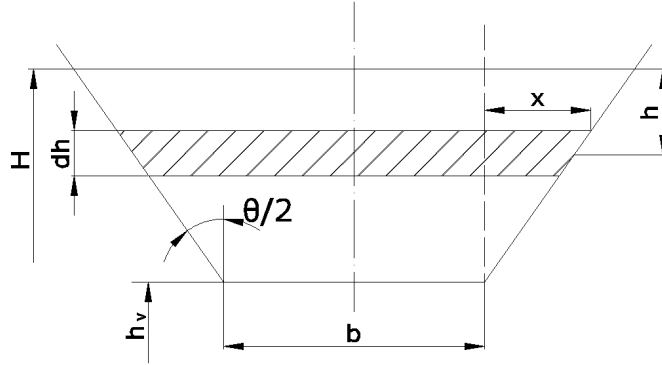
Sección transversal de un vertedero trapezoidal.
